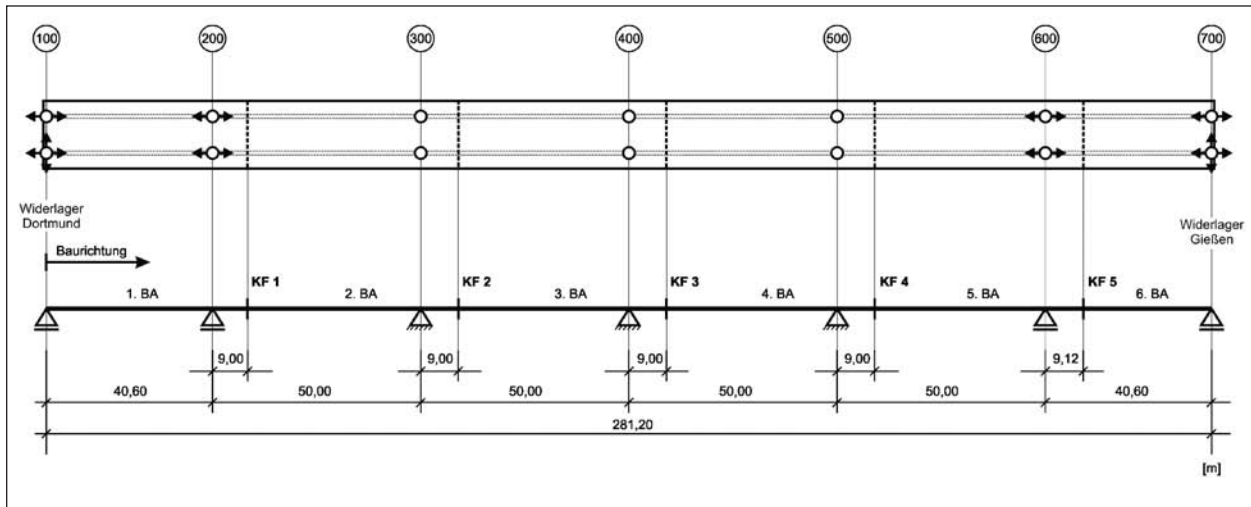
Ansicht und Grundriss der Volkersbachtalbrücke
